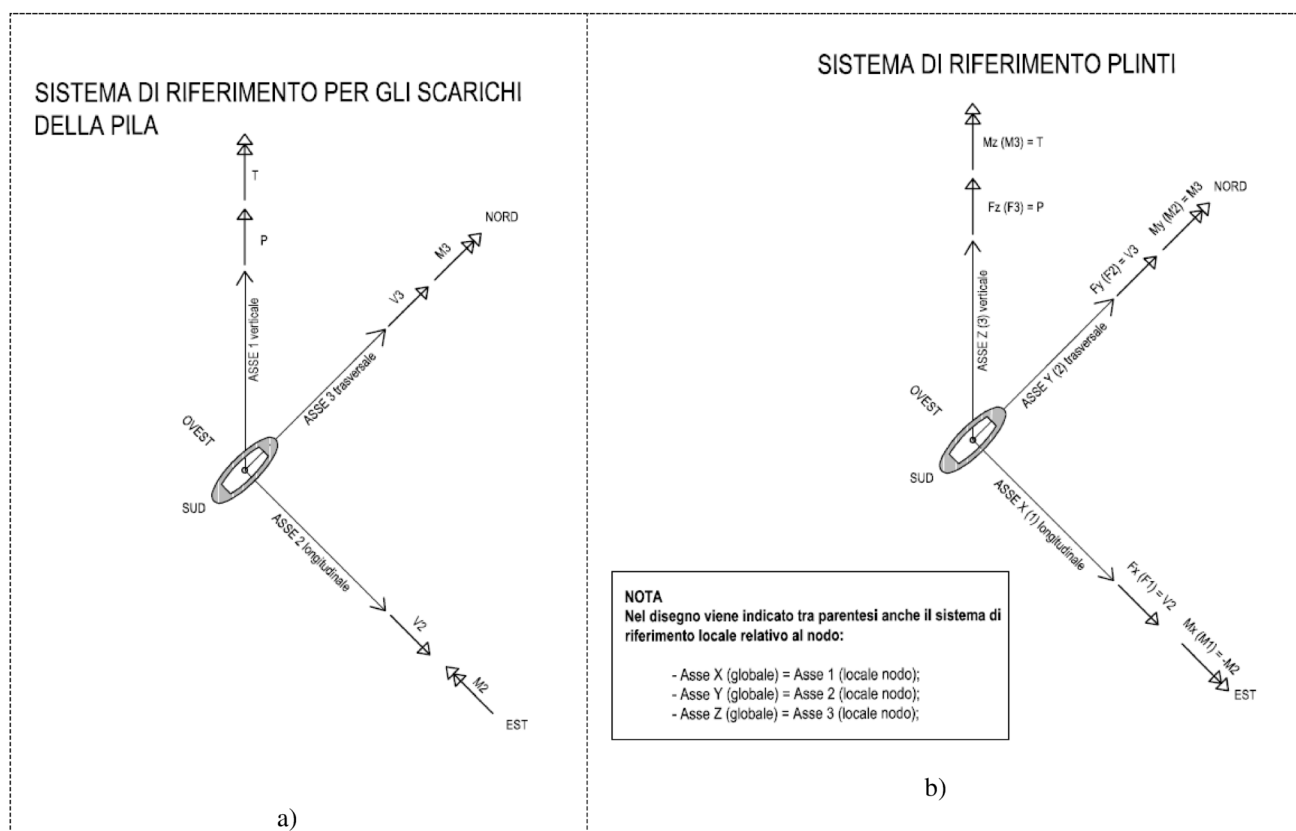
Convenzione scarichi in funzione dei SdR dei modelli di calcolo f.e.m.: a) scarichi trasmessi dalla base della pila a estradosso plinto di fondazione; b) scarichi applicati al plinto di fondazione in corrispondenza del nodo di base della pila.
